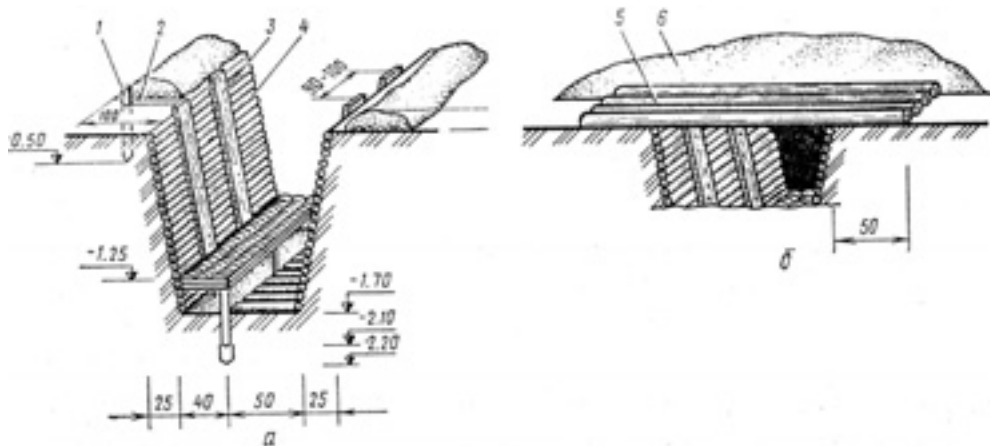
Щель с одеждой крутоостей: а – открытая; б – с перекрытием из бревен; 1 – кол; 2 – проволочная оттяжка; 3 – стойка; 4 – забирка; 5 – перекрытие из бревен; 6 – насыпной грунт
